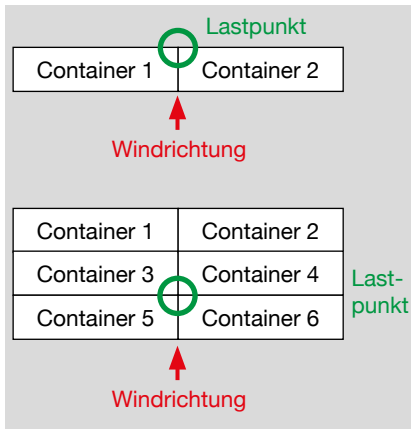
Grundrisse einer ein- und mehrreihigen Containeranordnung mit dimensionierungsrelevanten Lastpunkten
